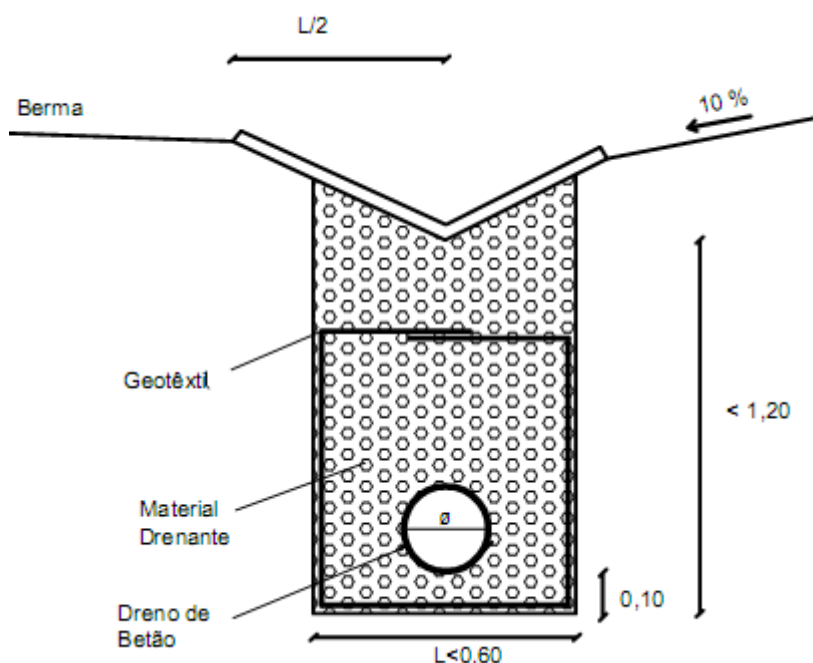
Dreno longitudinal de rebaixamento do nível freático [35]
